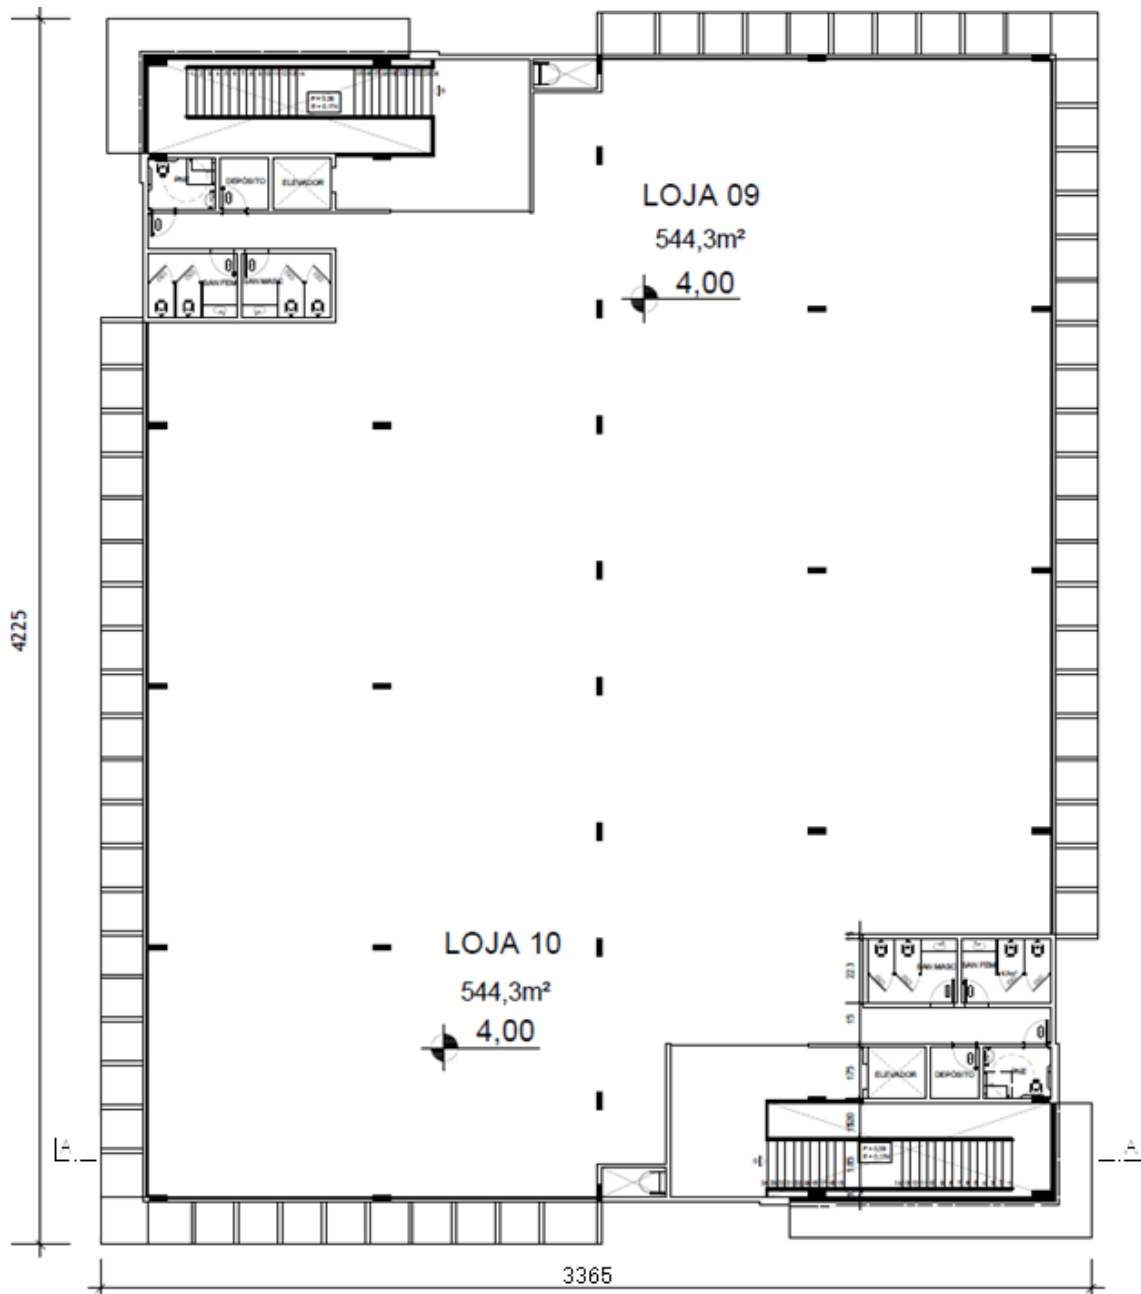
Planta de arquitetura do Pavimento Superior. (RR Roberto Arquitetura, modificada)
